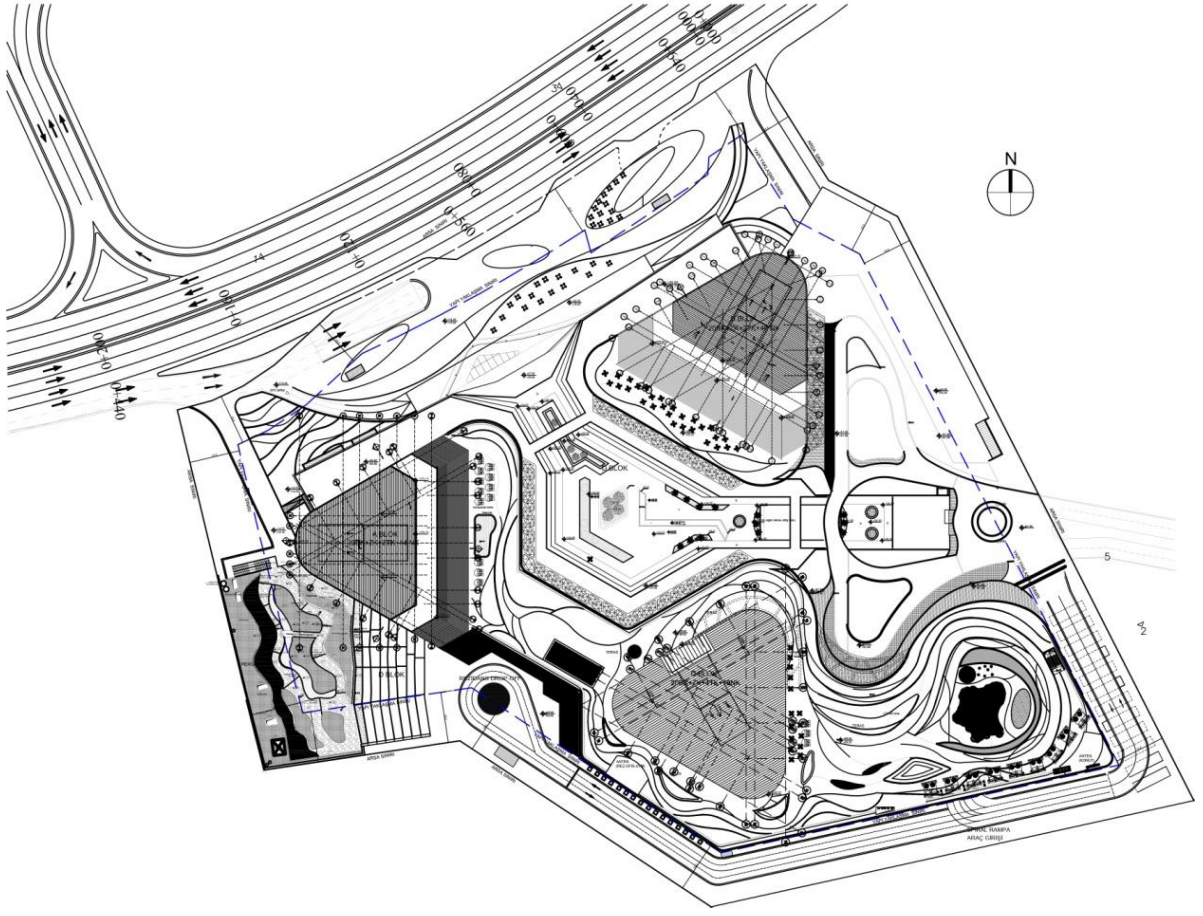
Vaziyet Planı Fonksiyon Şeması (Özbek, S.)
